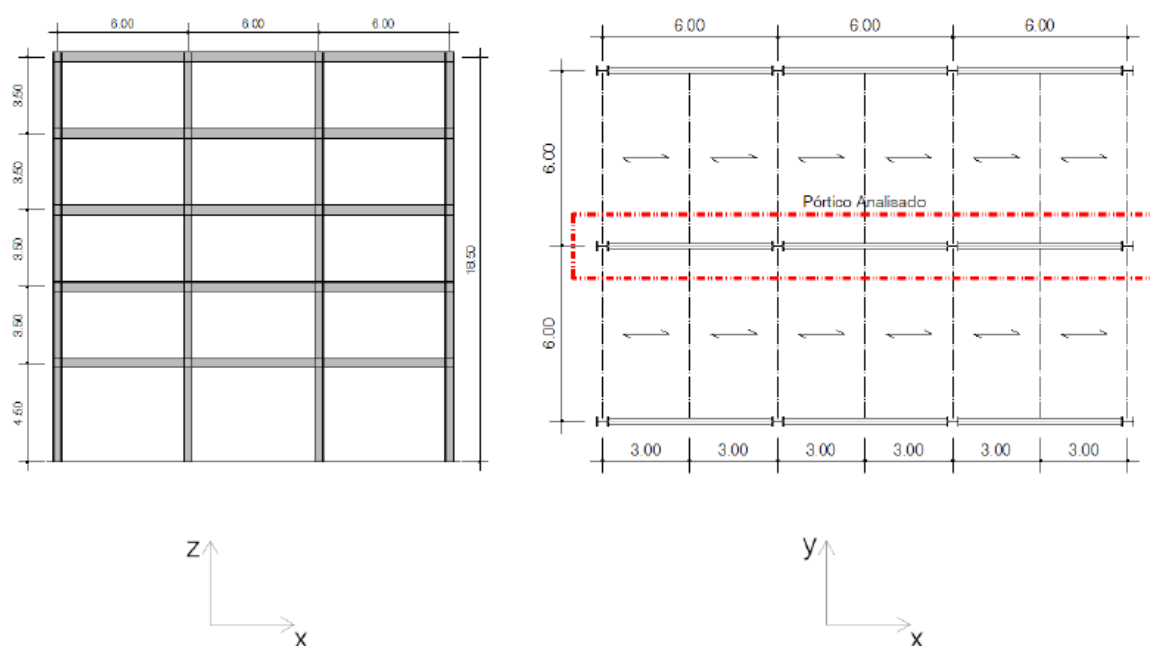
Alçado e planta da estrutura em análise [30]
